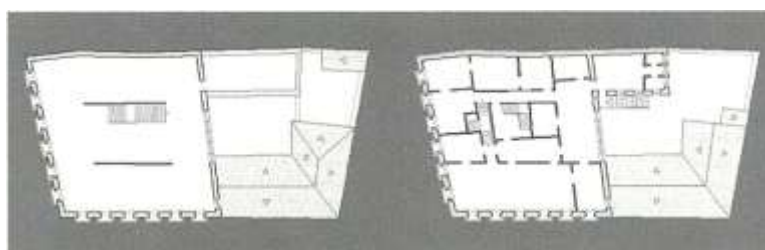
Plantas de reconstrução 2º pavimento: antes e depois da intervenção (1946-1952)
